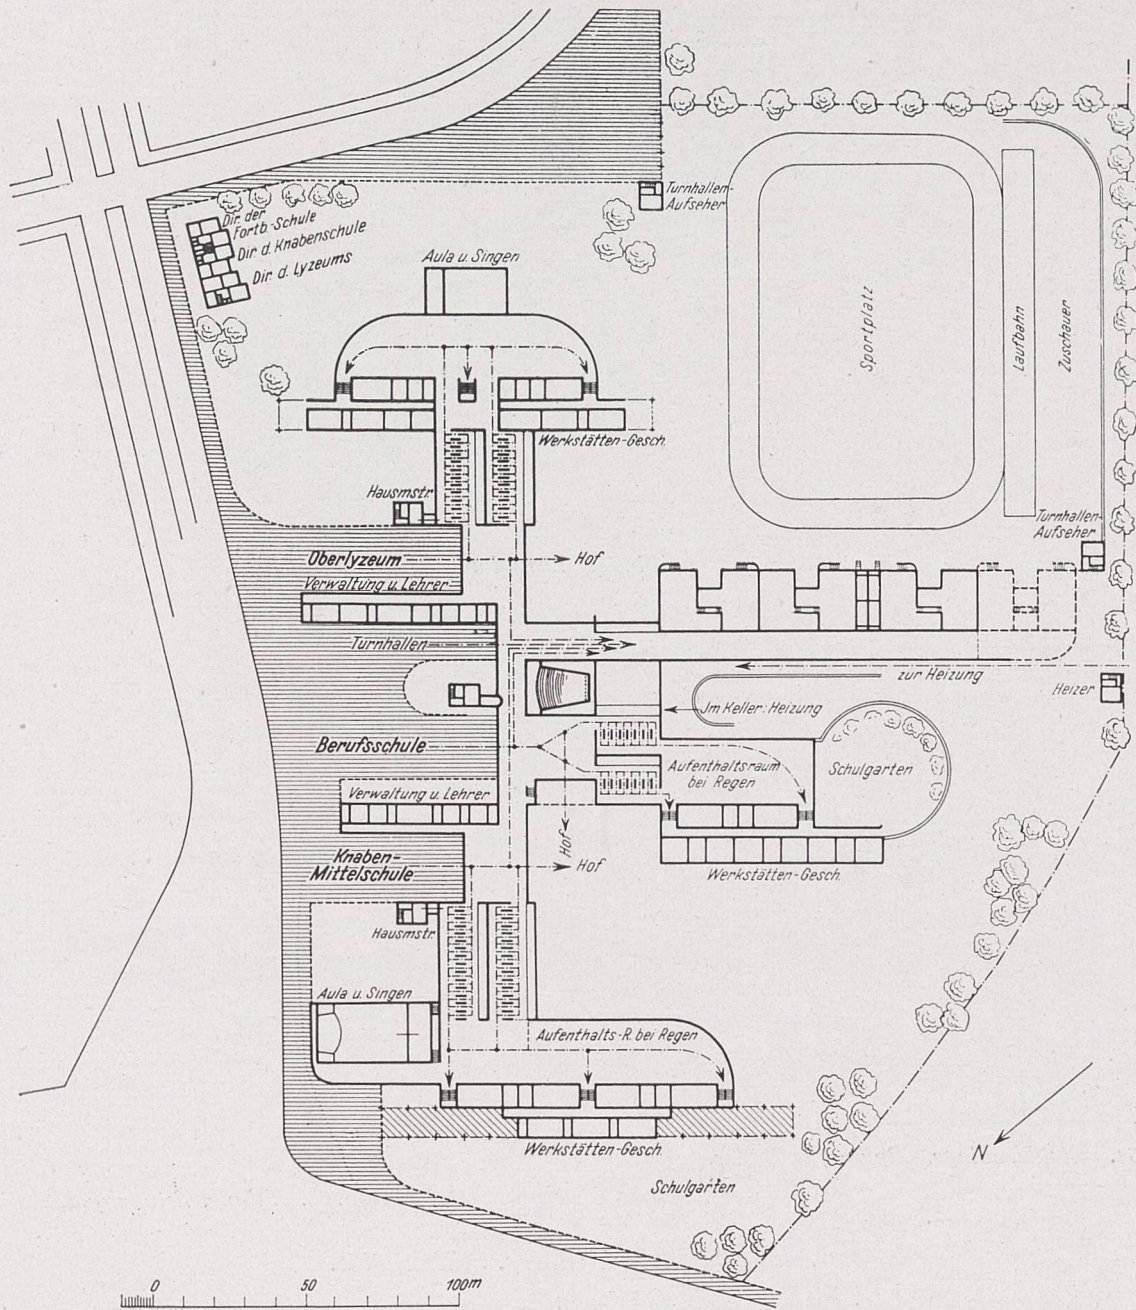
Grundriß des Erdgeschosses. Architekt Professor Hans Scharoun, Breslau.
